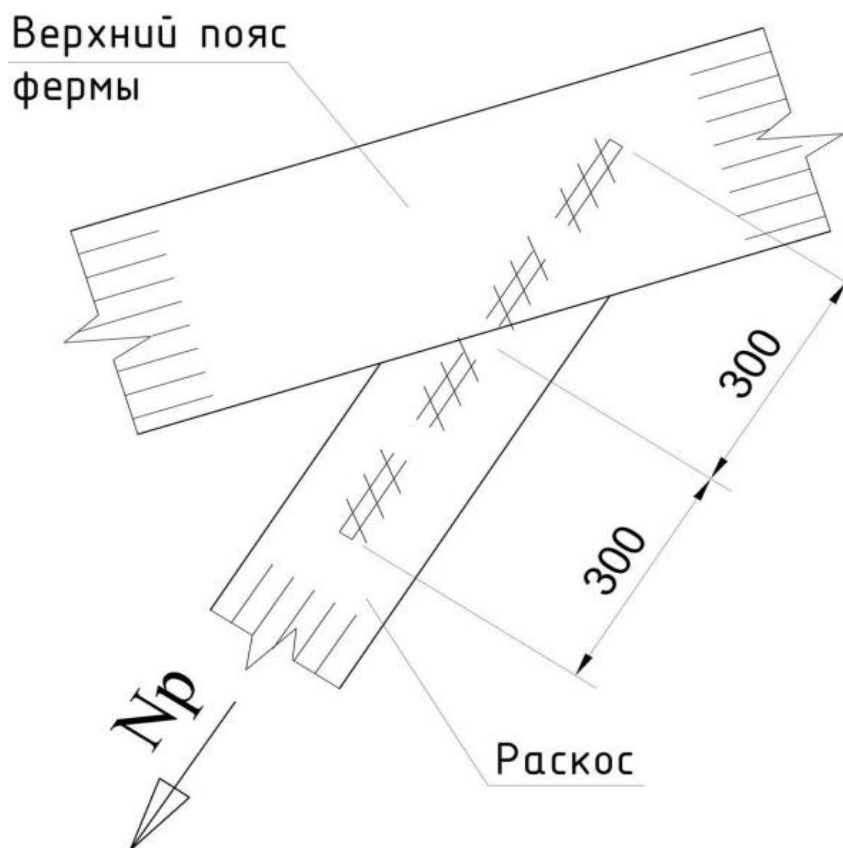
Конструкция узла крепления растянутого раскоса к поясу фермы
